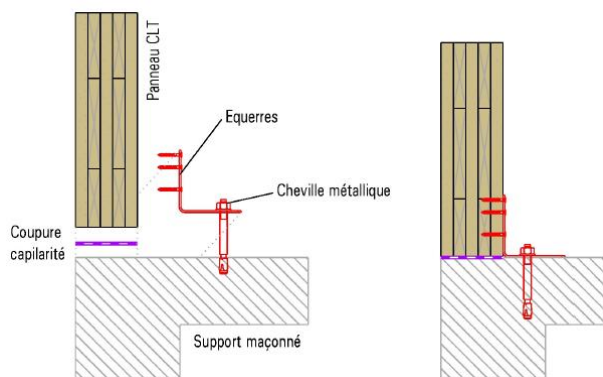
Equerres métalliques pour assemblage murs/fondations
